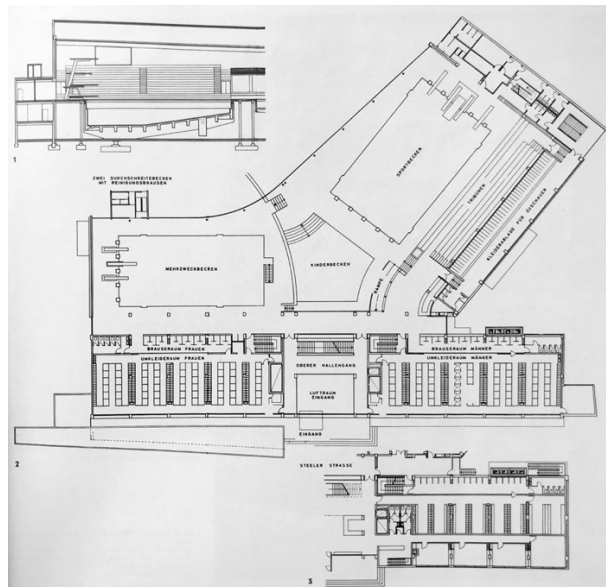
P. F. Schneider, Hauptbad Essen: Grundriss Hauptgeschoss (aus: *Baukunst und Werkform*, 1960, Heft 9, S. 489)
